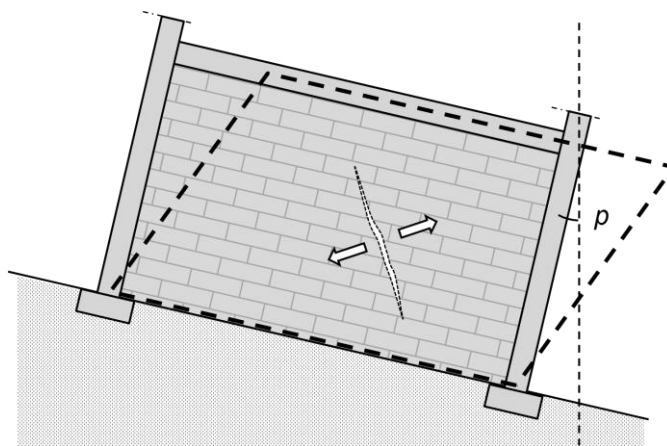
exemple de fissures diagonales induites par la mise en parallélogramme du mur de remplissage en cas de mise en pente du terrain
